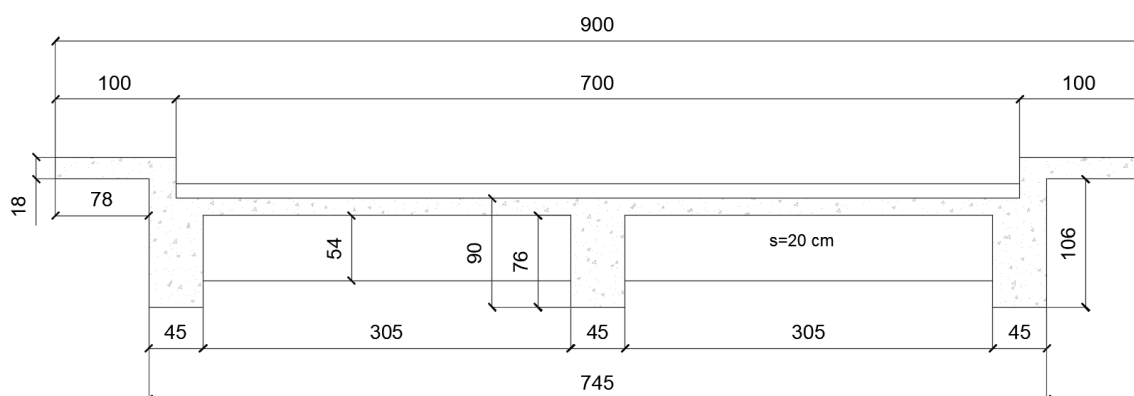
Sezione trasversale dell'impalcato del ponte (quote in cm)
